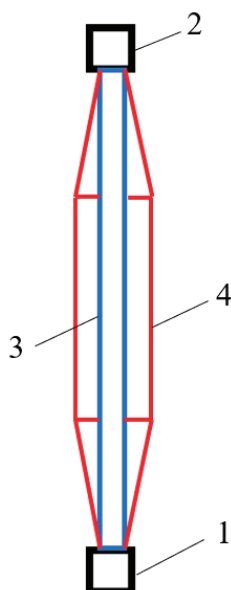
Усиление сжатых стоек фермы: 1 — нижний пояс фермы, 2 — сжатый пояс фермы; 3 — усиливаемая стойка, 4 — предварительно-напряжённая шпренгельная система
